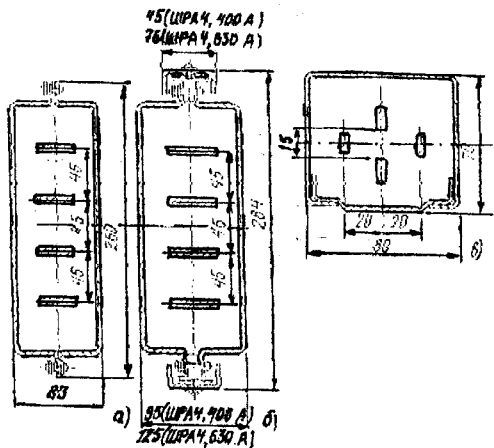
Поперечний переріз шинопроводів ШРА4-250-32-1УЗ (а), ШРА4-400-32-1УЗ, ШРА4-630-32-1УЗ (б). ШРА4-100-44-1УЗ(в)
